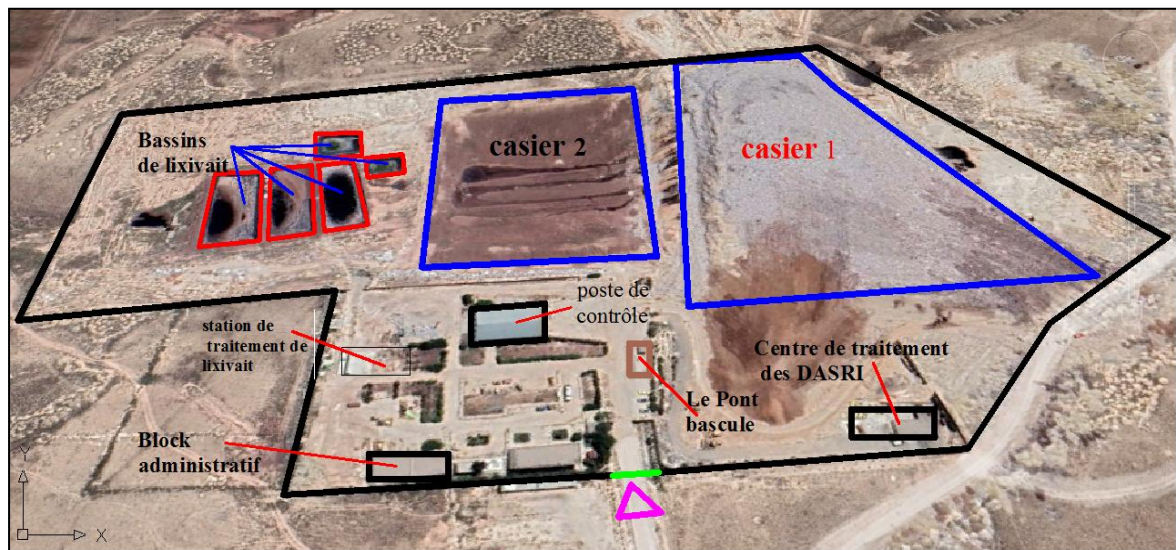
Plan d'aménagement CET Baghai Khenchela
